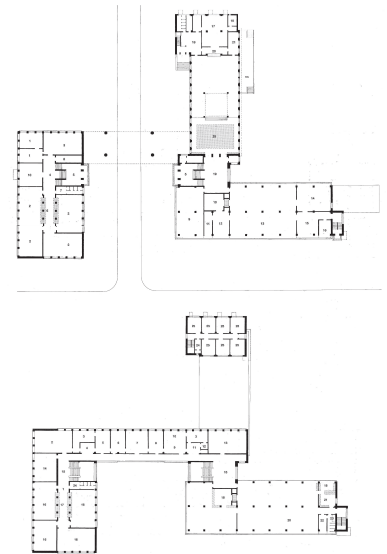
Plans du bâtiment. En haut, niveau 1, au dessous, niveaux 2 et 3.
